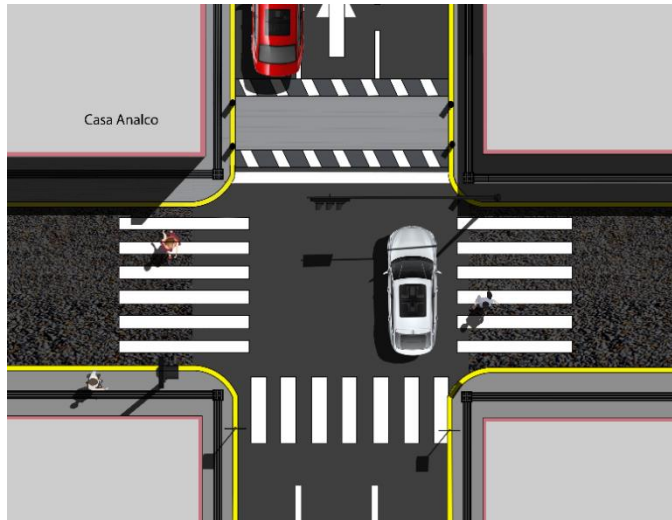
Vista en planta de la propuesta de intersección. Calle 14 sur y 7 oriente.
